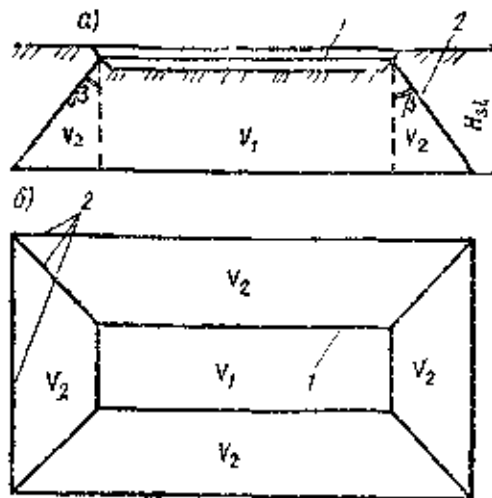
Поперечный разрез (а) и план (б) увлажненной зоны котлована
